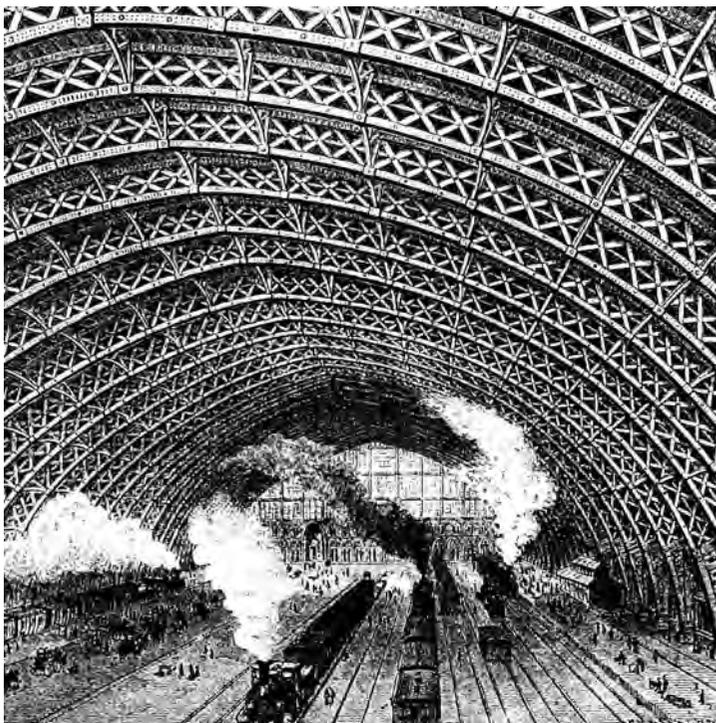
Bahnhofshalle St. Pancras, London, Baujahre 1863 – 1865, aus /93/
